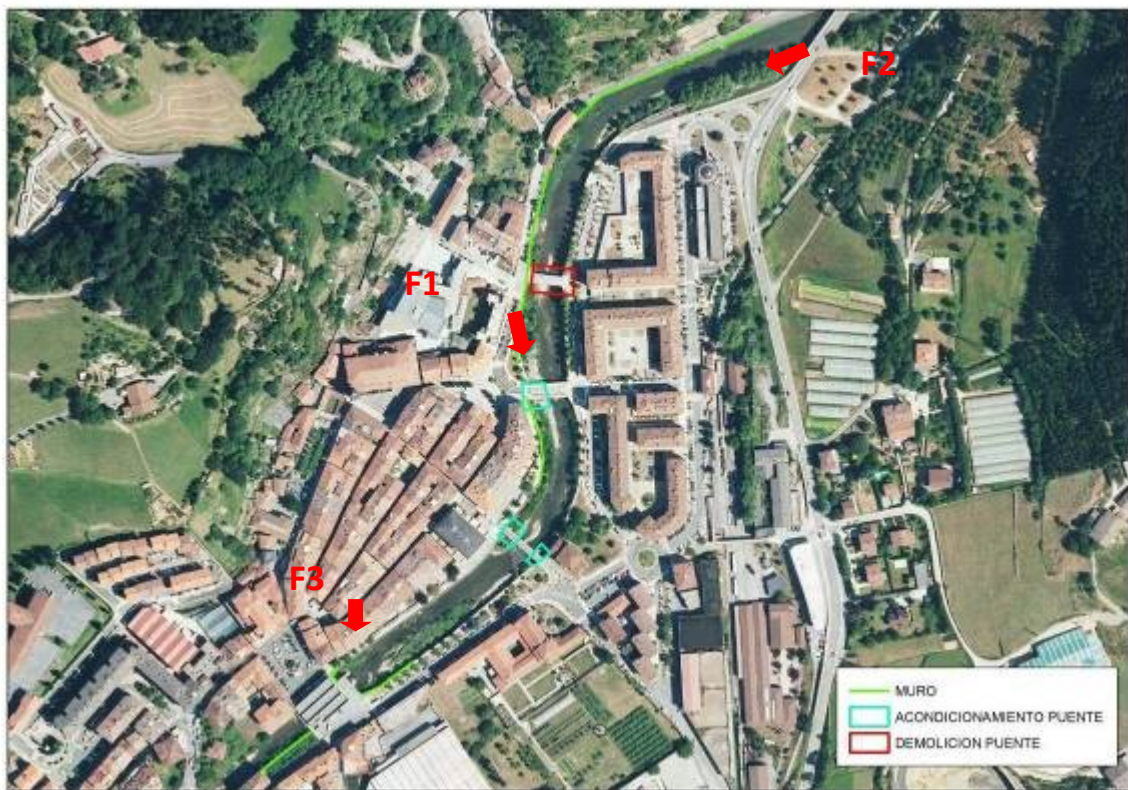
Ubicación en planta de las actuaciones y de las fotografías posteriores.
